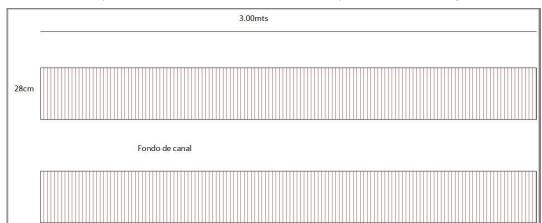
Plano de planta de canales dentro del Estanque Virreinal de Agua.
